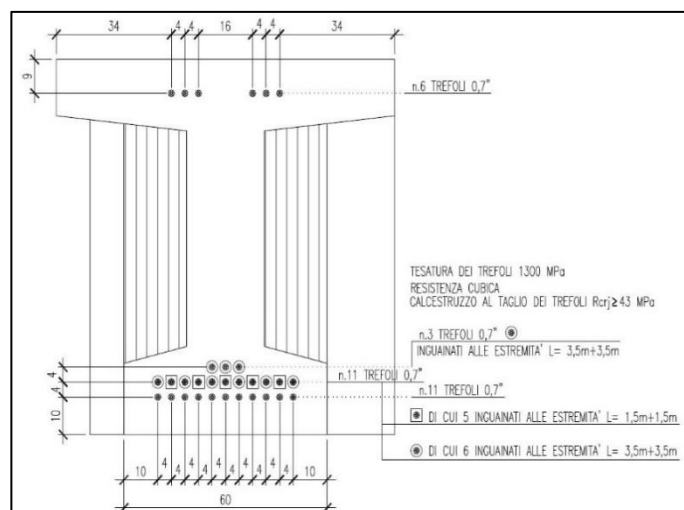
Sezione trasversale trave prefabbricata tipologica (posizione trefoli)
